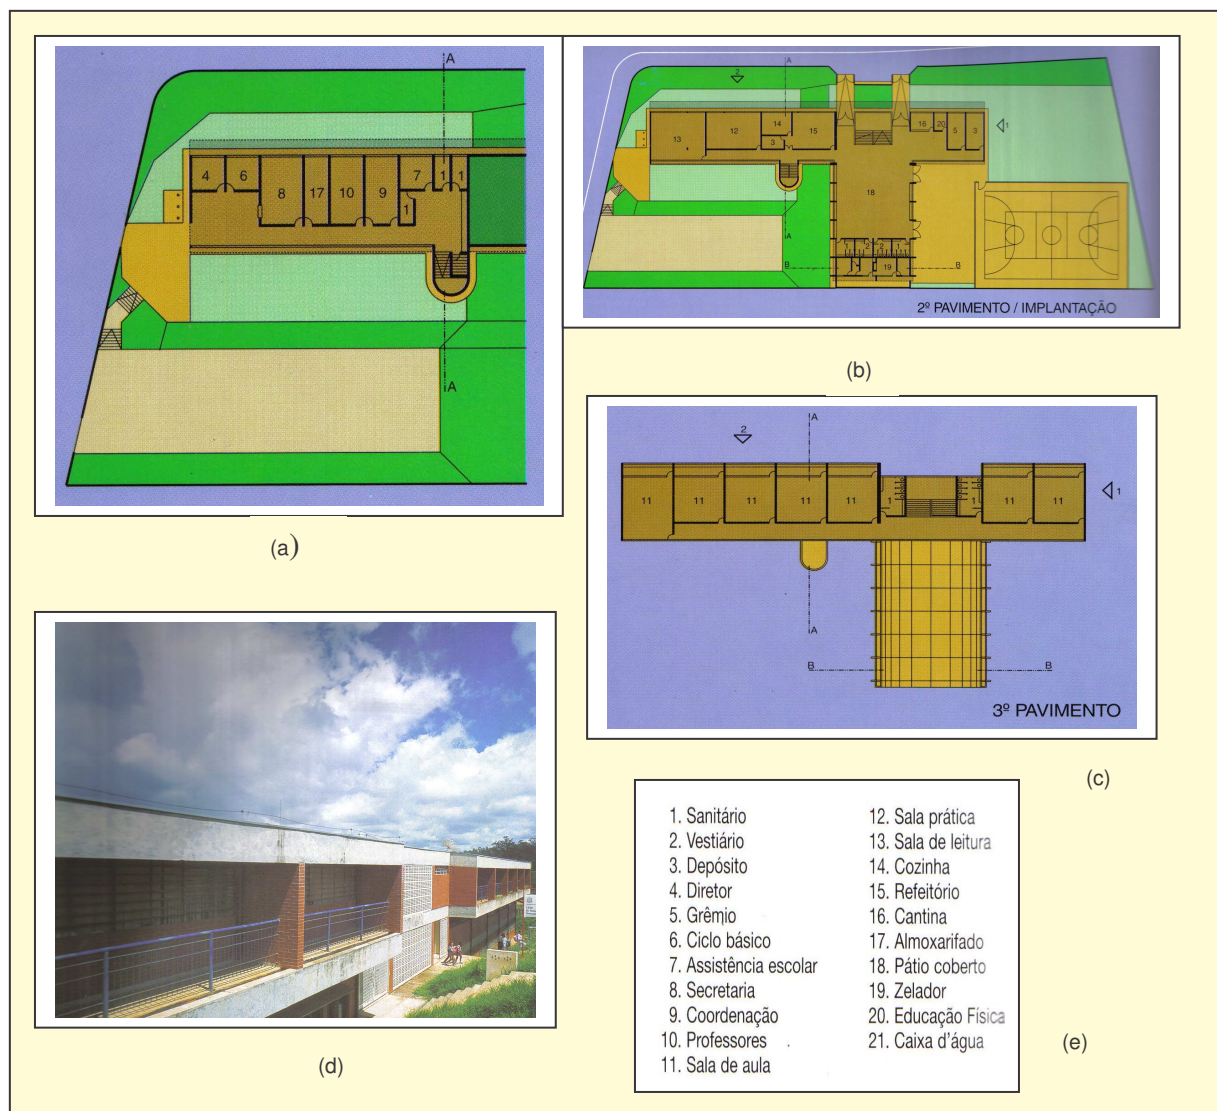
Escola Disney Francisco Scornienchi (1995-1998) implantada em Campinas, SP. (a): planta baixa da implantação e pavimento térreo; (b): planta baixa do 2.º pavimento; (c): planta baixa do 3.º pavimento; (d): vista da fachada; (e) legenda.
